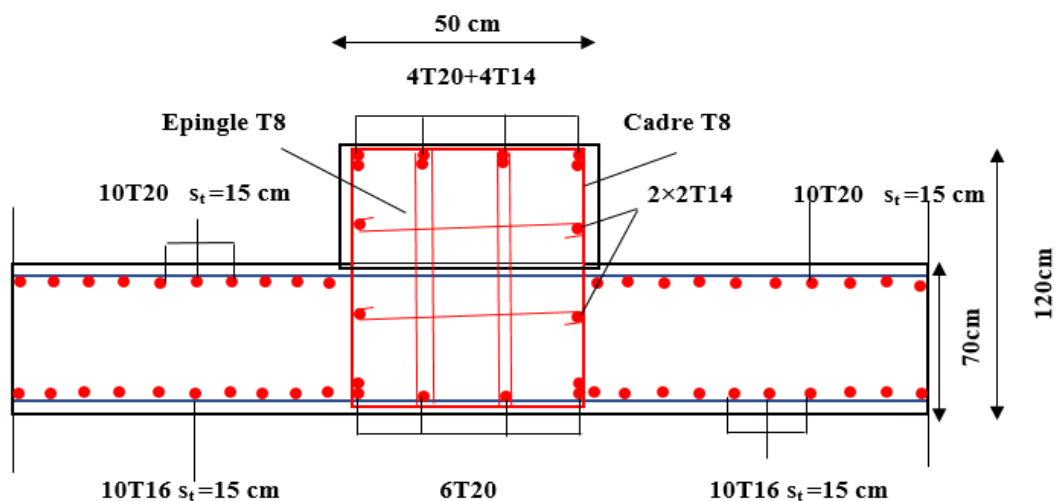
Ferrailage des nervures sens X sur appuis.
